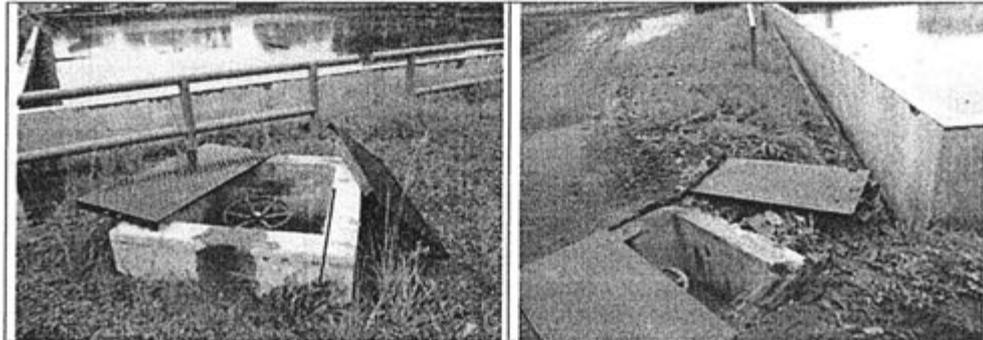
Vista de una parte de la poza clarificadora que no cuenta con muro de contención (aproximadamente 20 metros)
